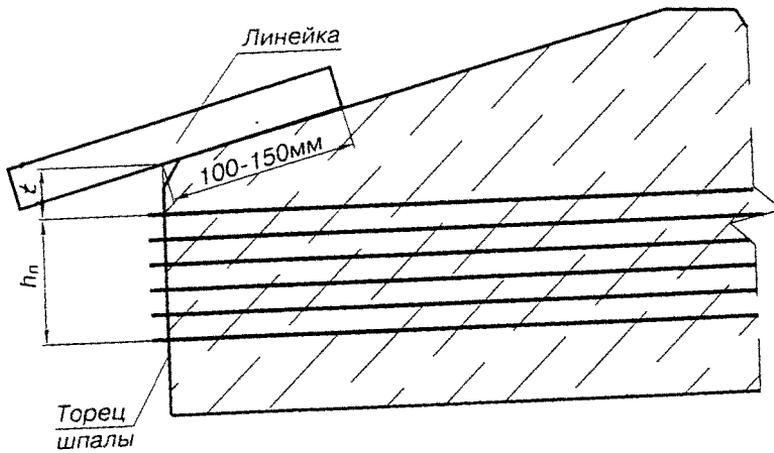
Схема определения толщины t защитного слоя бетона и высоты h_n пакета проволок арматуры на торце шпалы
